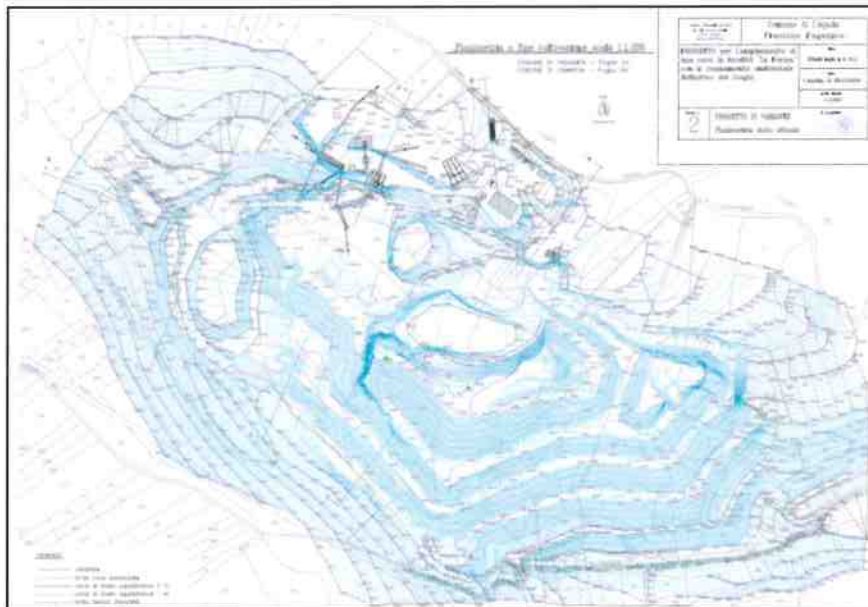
Planimetria Stato di Fatto (da elaborato n. 2 allegato allo SPA)
